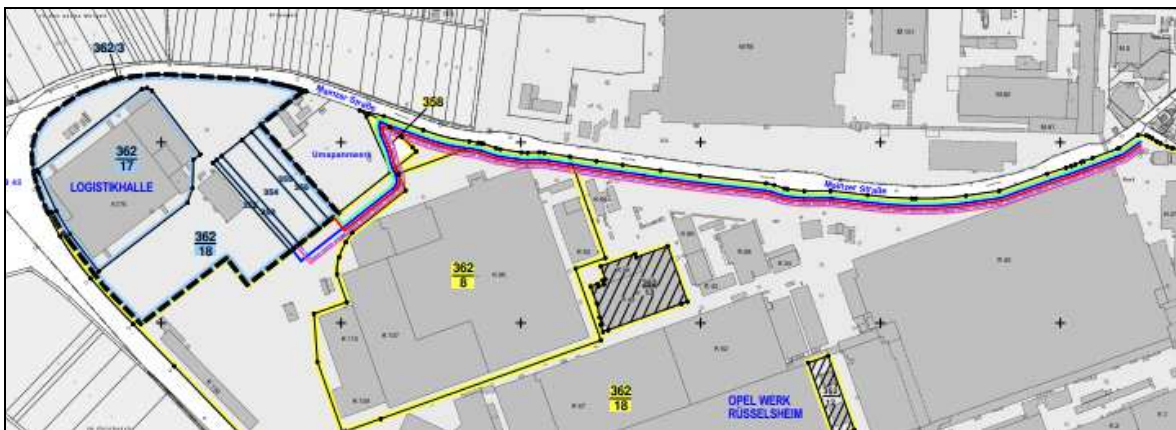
Lageplan, Leitungsrecht auf Stellantis Grundstück entlang der „Mainzer Straße“ (vgl. Anhang A-04)
